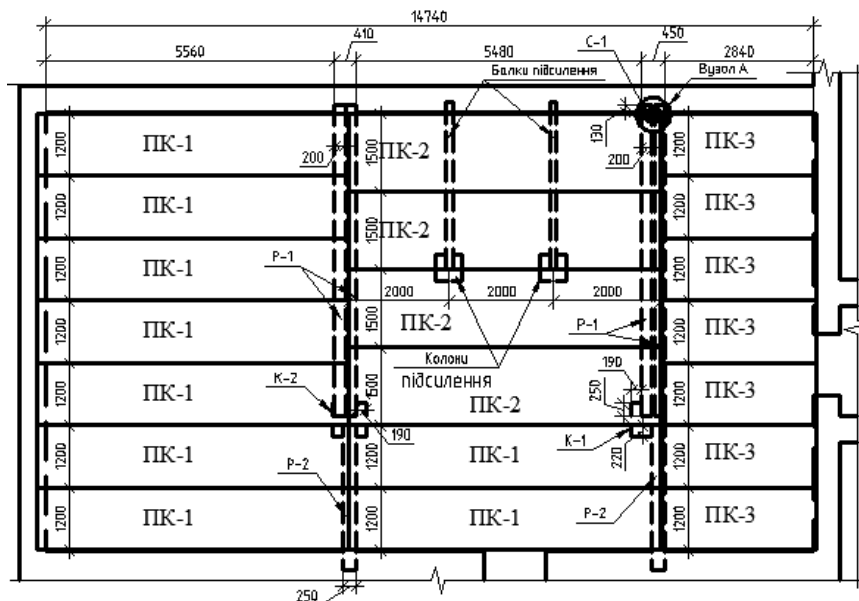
План перекриття з маркуванням конструкцій приміщення підвалу добудови
